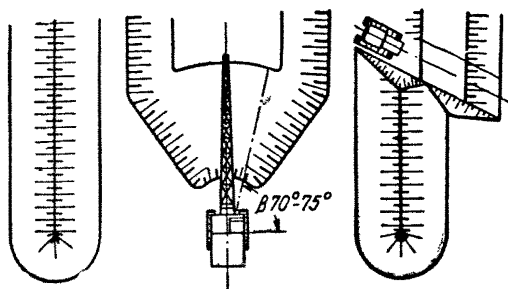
Схема расположения драглайна при продольном способе разработки в двусторонние кавальеры с перемещением грунта бульдозером из вала в кавальеру
